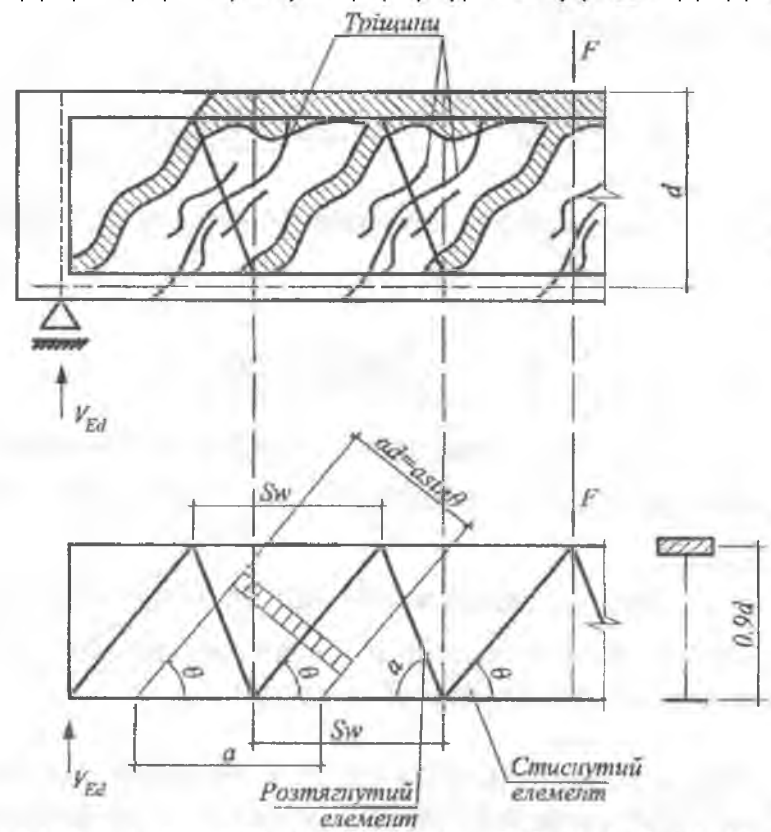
Розрахункова схема до визначення похилого перерізу
